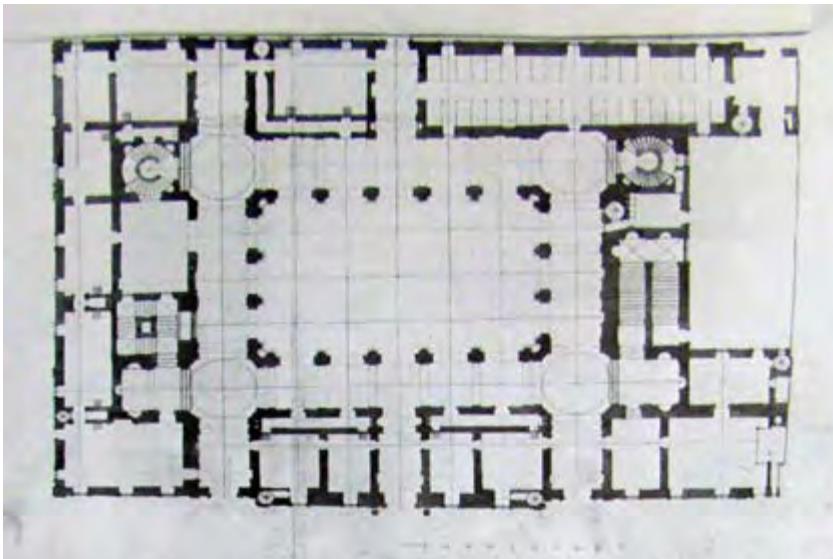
Carlo Fontana. Planimetria del pian terreno del secondo progetto per palazzo Sternberg a Praga (1696-1700) (da HAGER 1977, fig. 309).
